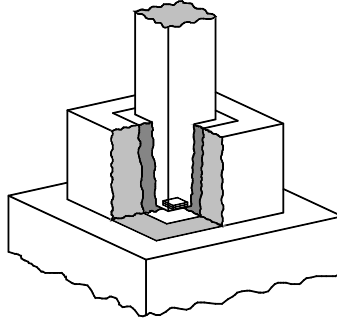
Ligação pilar-fundação em cálice (Lúcio, 2000).
